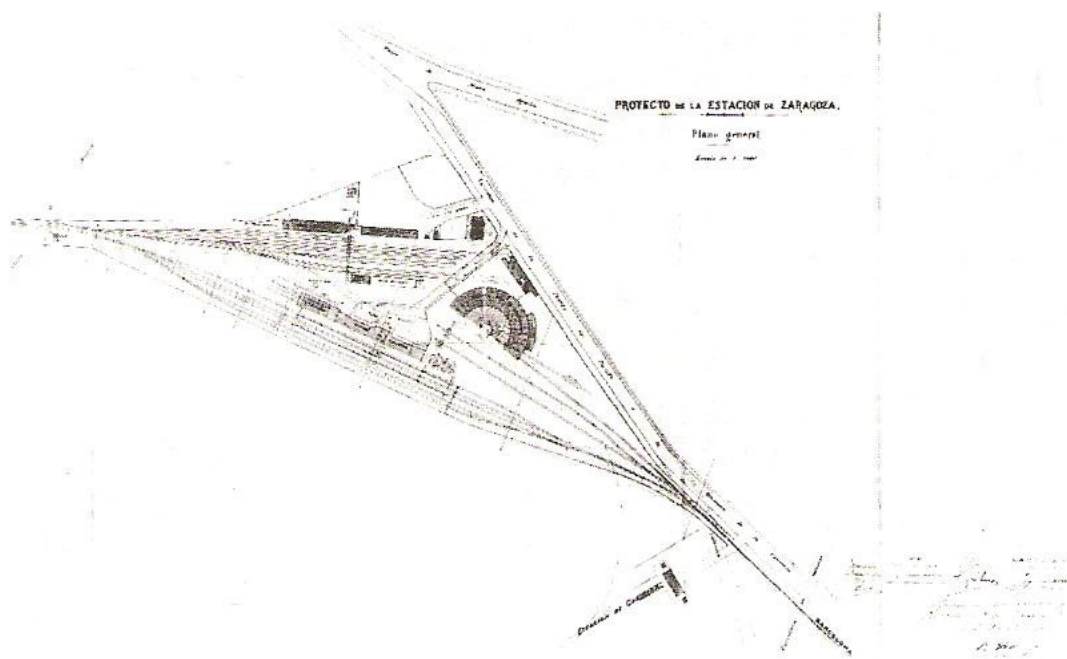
Vista en planta de las instalaciones. Fuente: López García.
